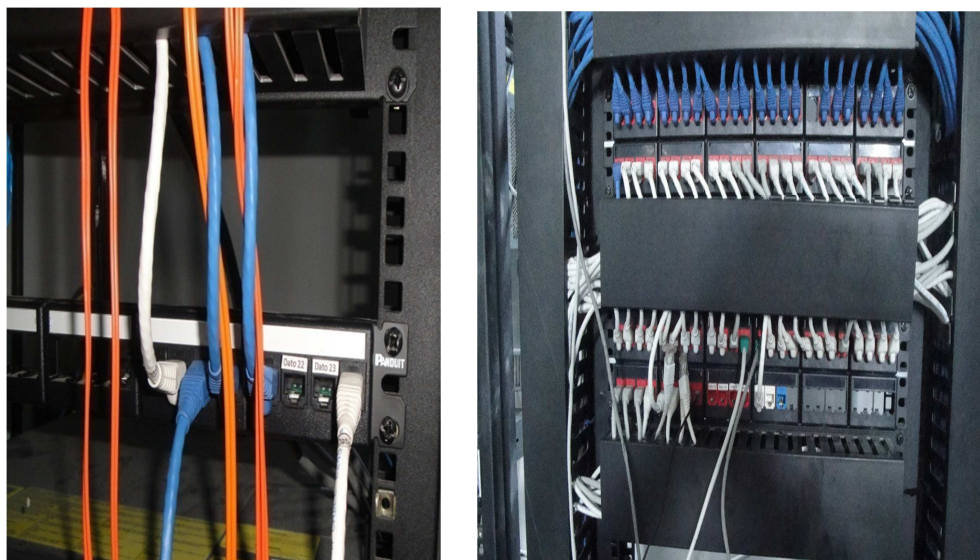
Racks de la planta baja. Nodo principal (2).
